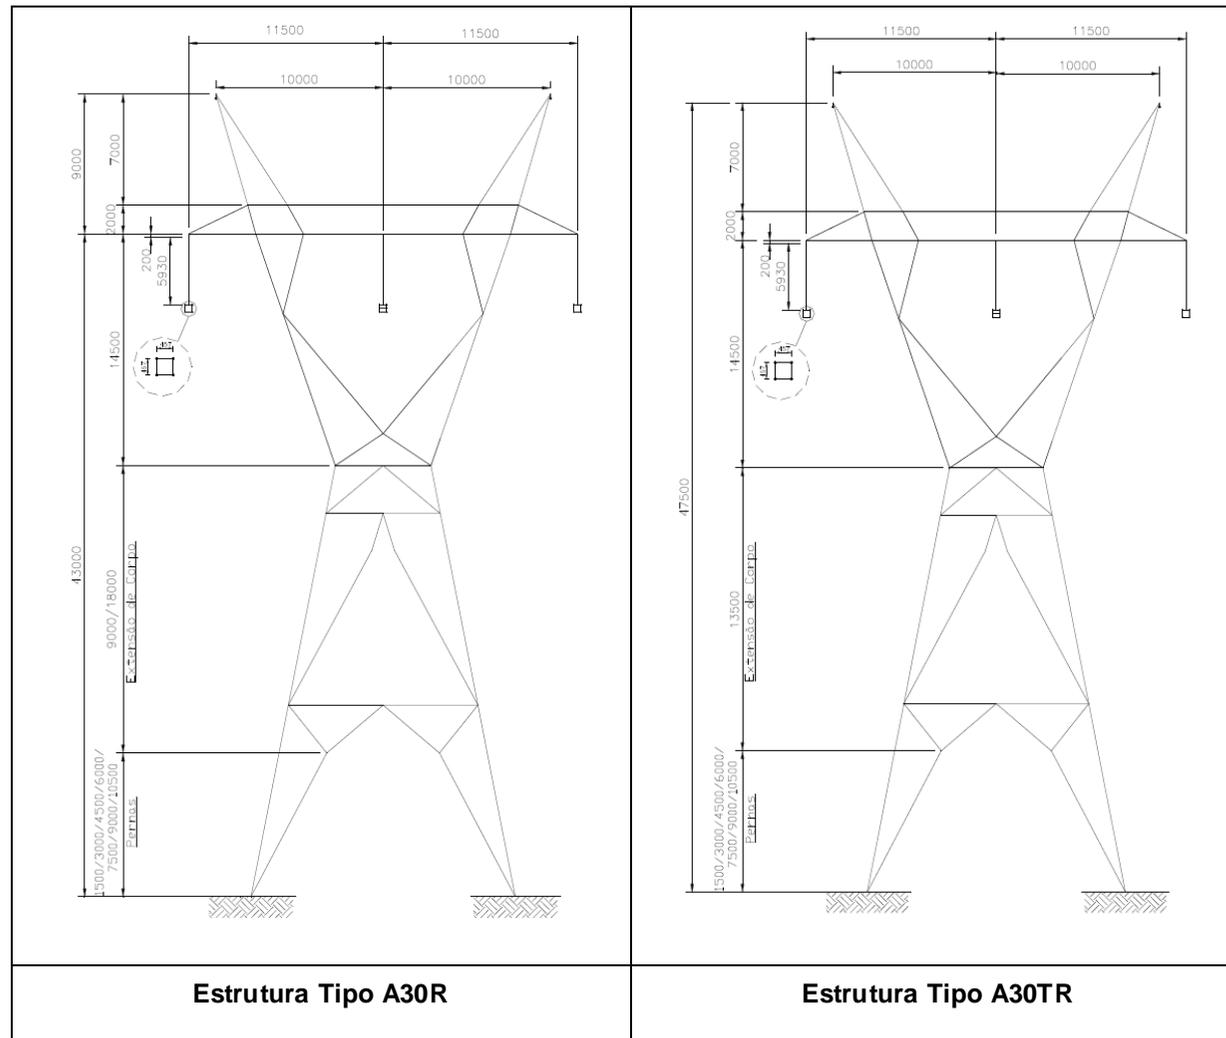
Tipos de Estruturas a serem utilizadas na LT Candiota – Aceguá.
